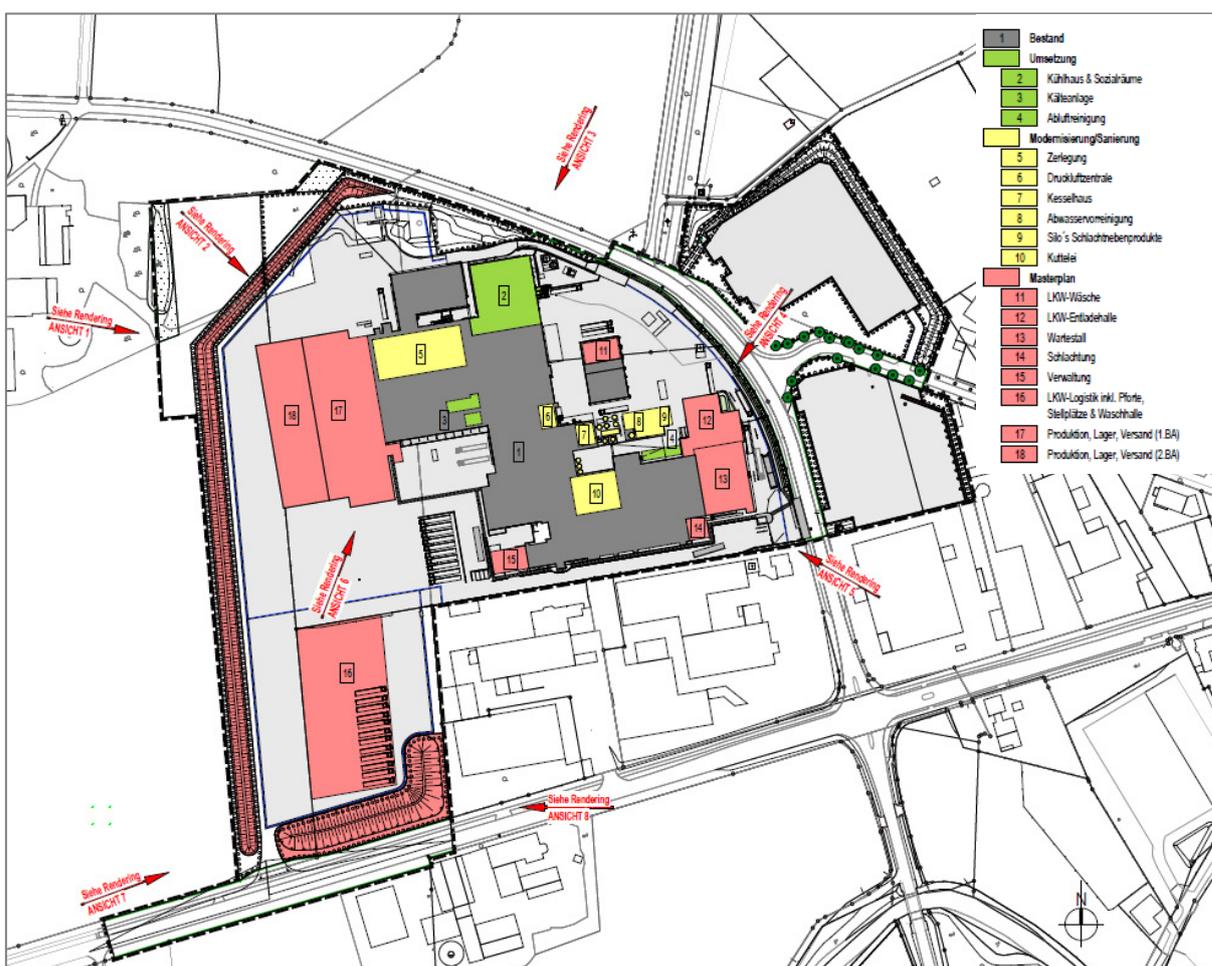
Lageplan (Stand 17.12.2020) (ATP ARCHITEKTEN INGENIEURE 2020).
